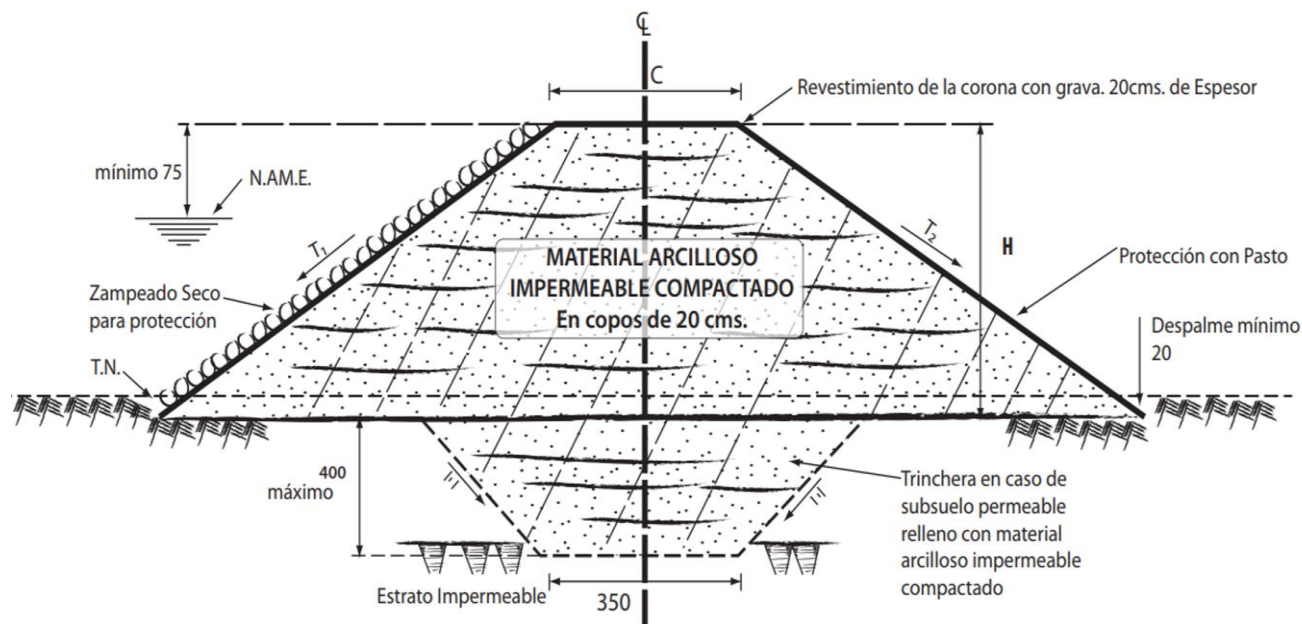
Propuesta de sección tipo del BMMH.
